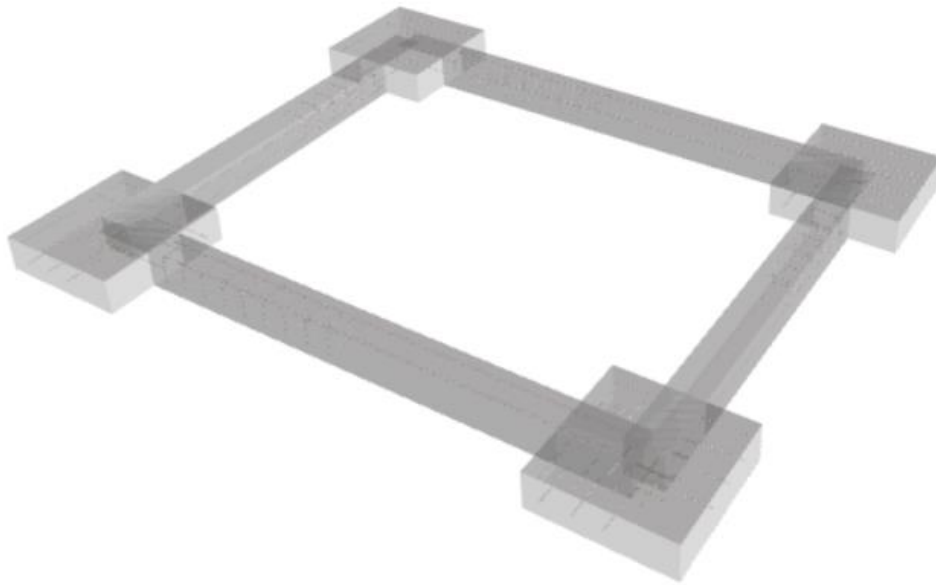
Cimentación de la caseta. Pr. Cype3D. Realización propia.
